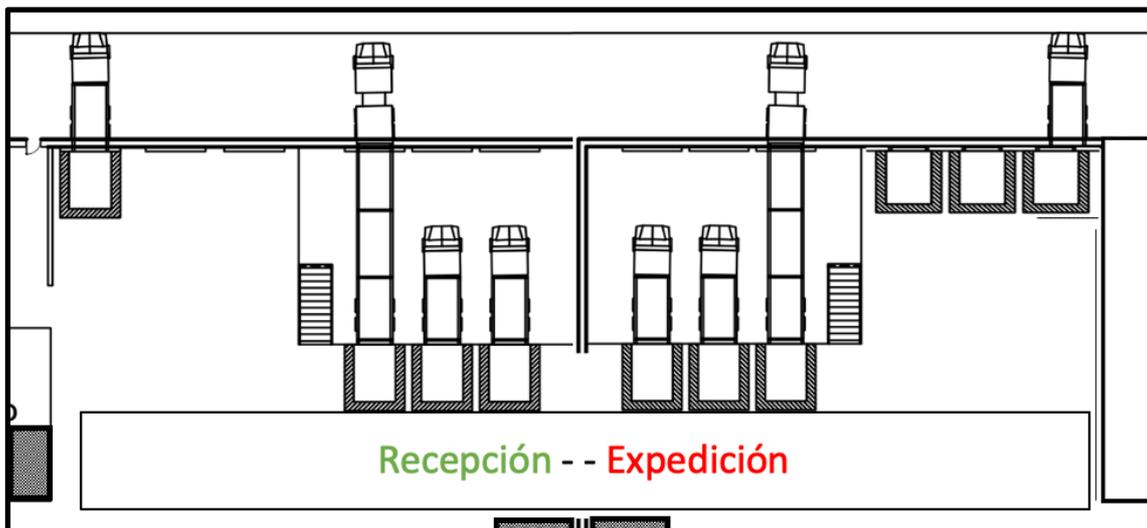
Zona de recepción y expedición planta principal. Fuente: Elaboración propia.
